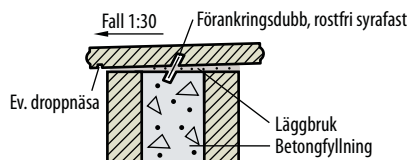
Avtäckning på dubbelsidig beklädnadsmur.
